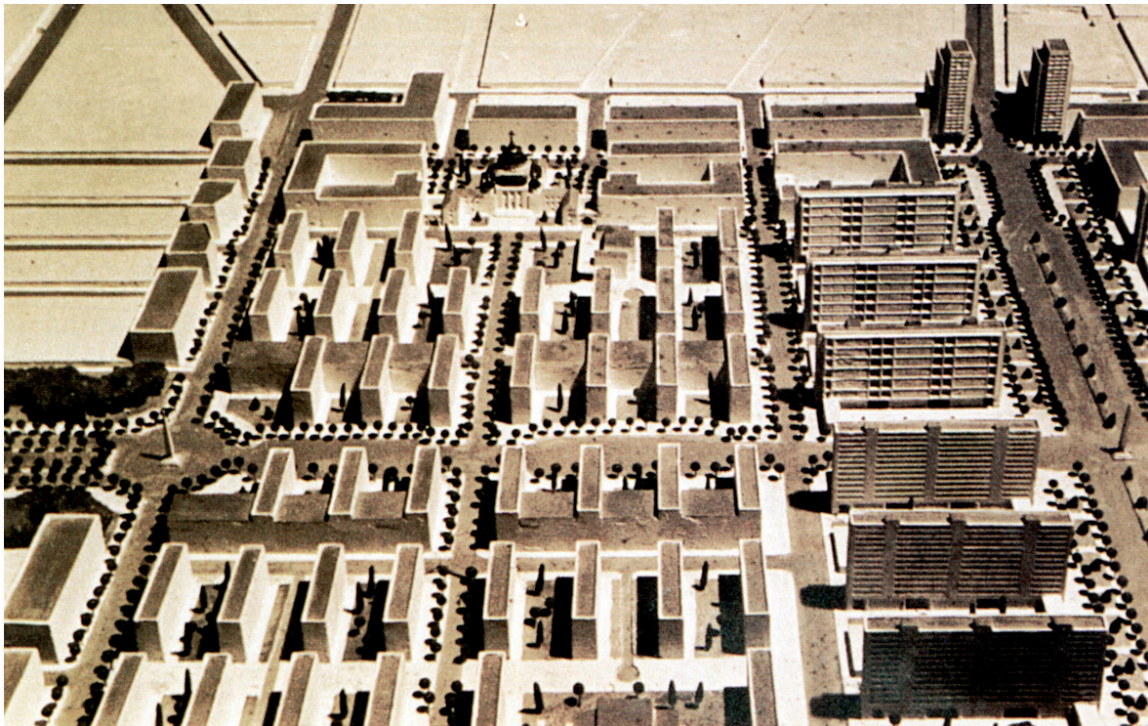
Vista de la maqueta del Plan Parcial de la Hoja 12-B de 1952.
